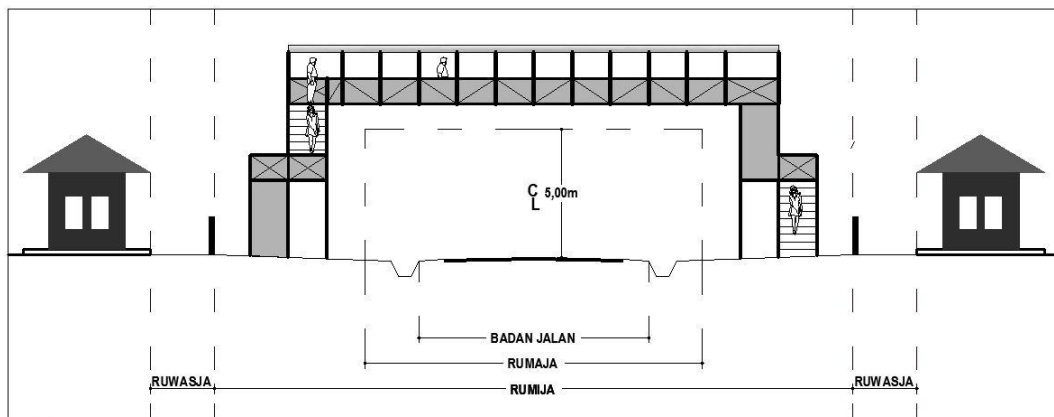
Contoh Penempatan Pos Pantau dan Bangunan Gedung Sementara di Ruang Milik Jalan Tipe 1
